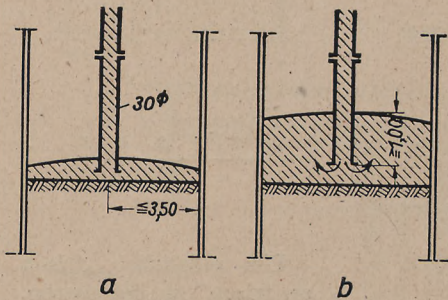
Unterwassergußbeton nach dem Contractor-Verfahren
